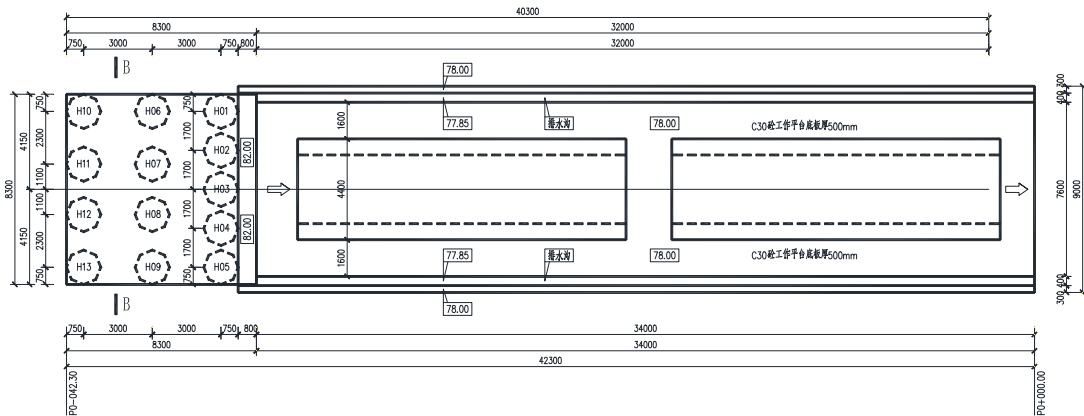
崩冲顶进箱涵后背墙群桩平面布置示意图
